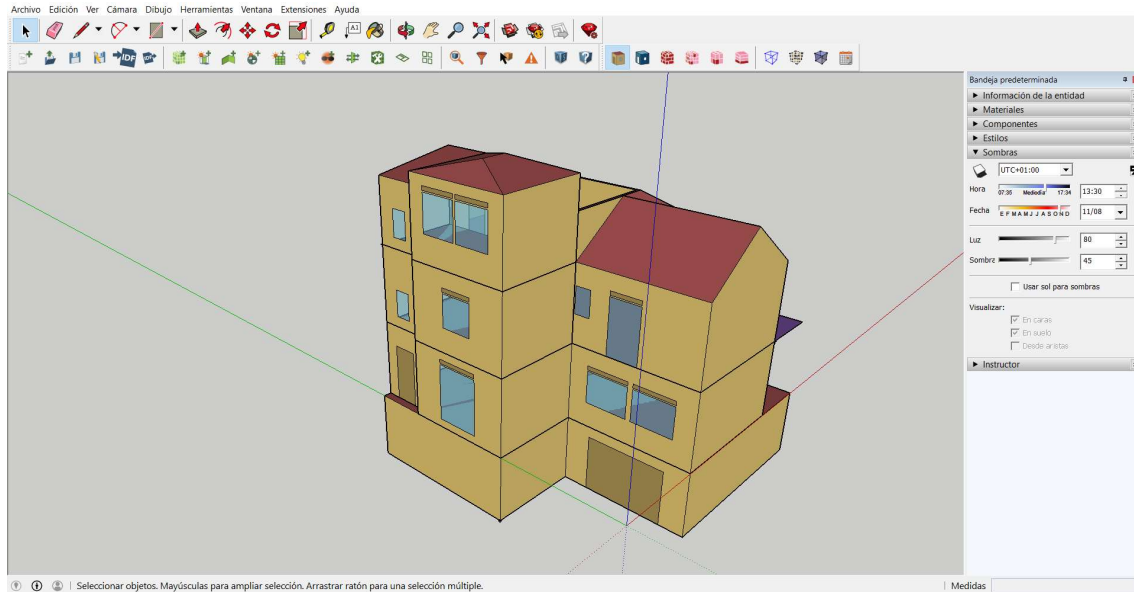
Aberturas en fachadas. Fuente: Elaboración propia
